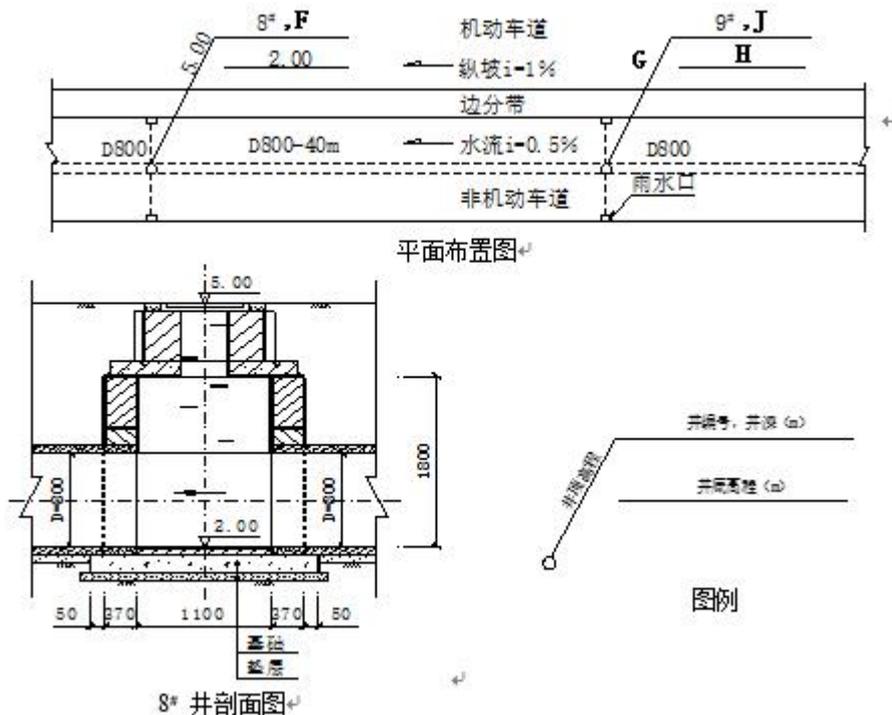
8#~9#雨水井段平面布置示意图 (高程单位: m; 尺寸单位: mm)
